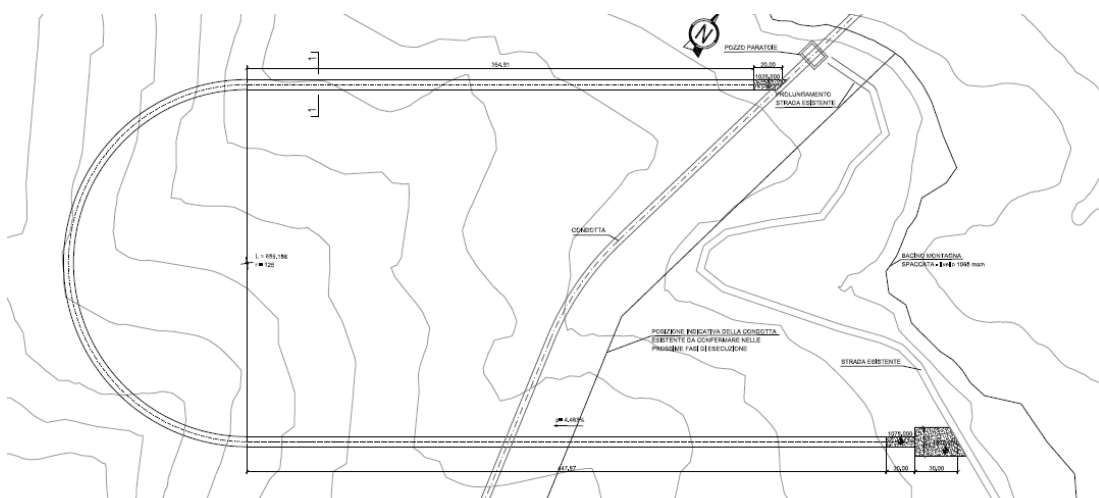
Pianta Galleria Di Accesso Al Pozzo Paratoie
